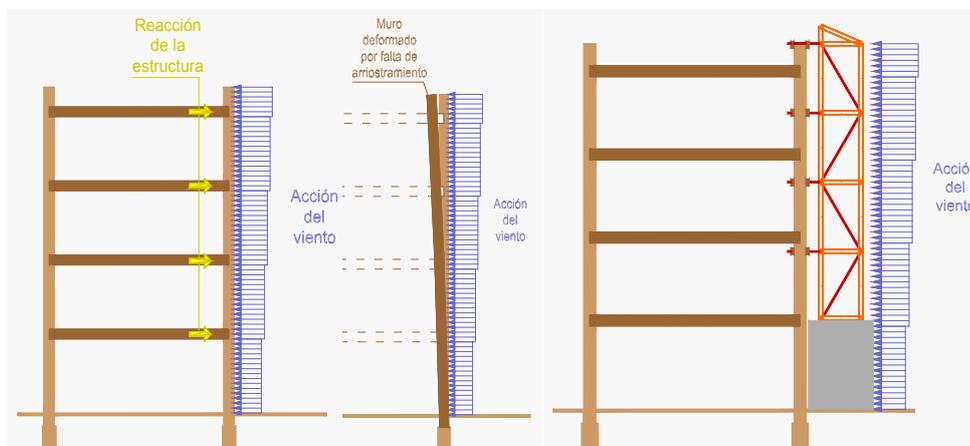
Esquema de la función de arriostramiento de un estabilizador de fachada
